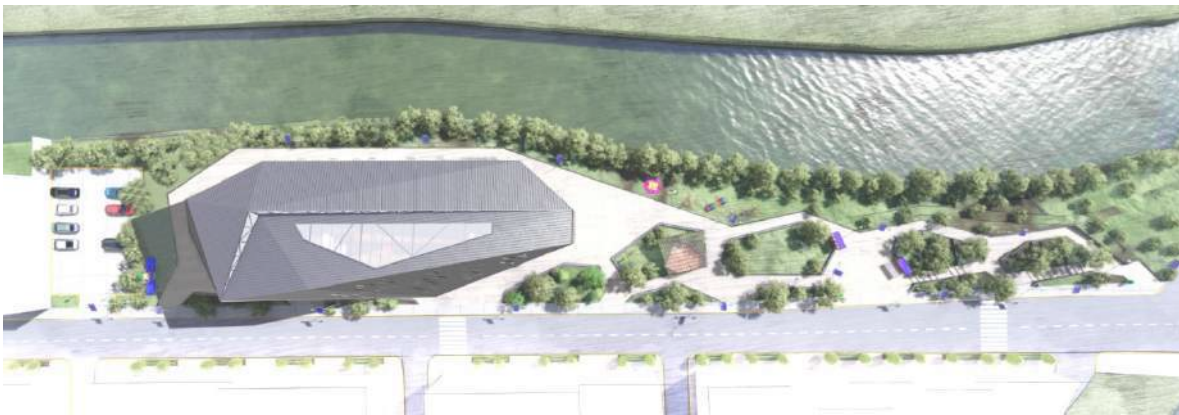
Ubicación de Barrera Verde Viva en Plot plan
